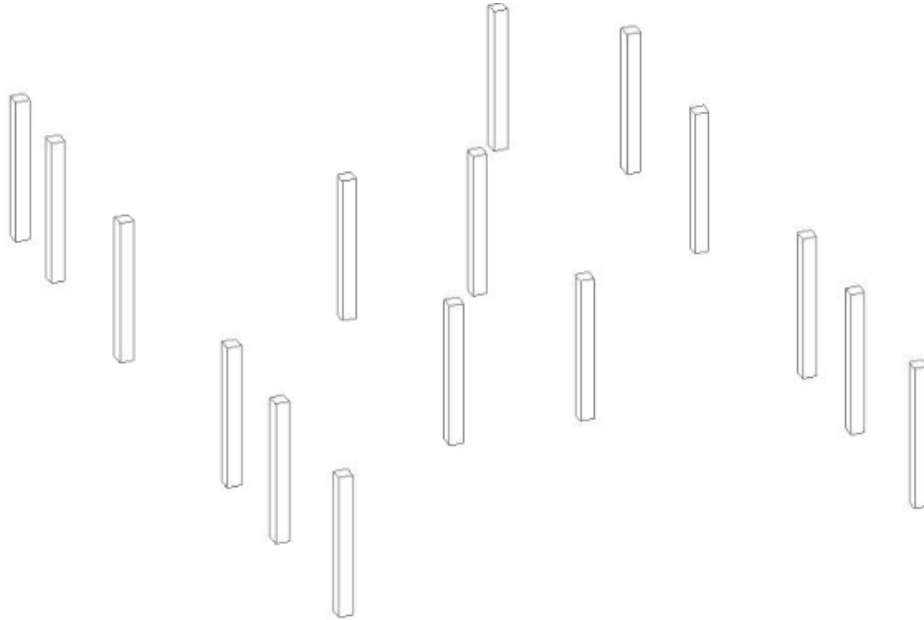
Modelado de pilares. (Fuente: Elaboración propia)
